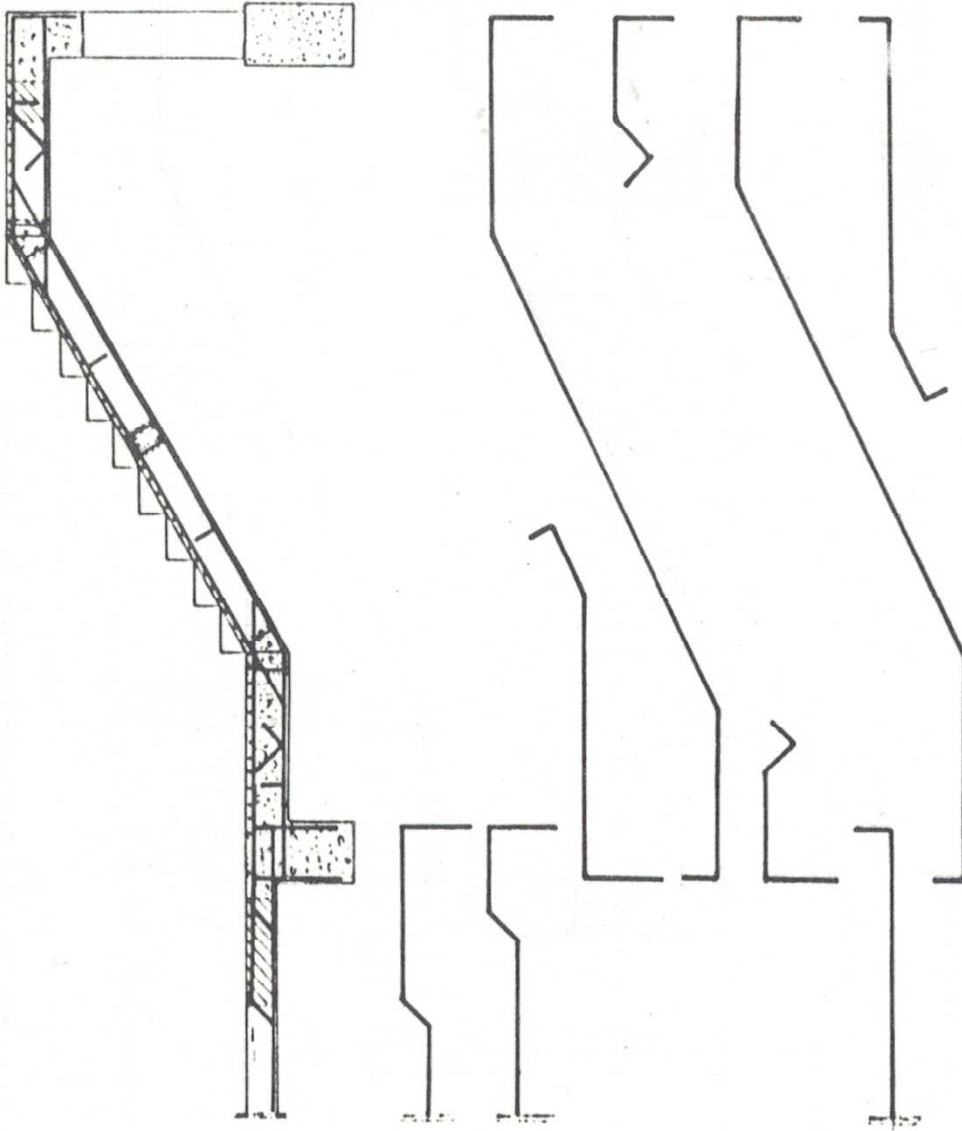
Disposizione delle armature dei travetti (rampa in salita)
